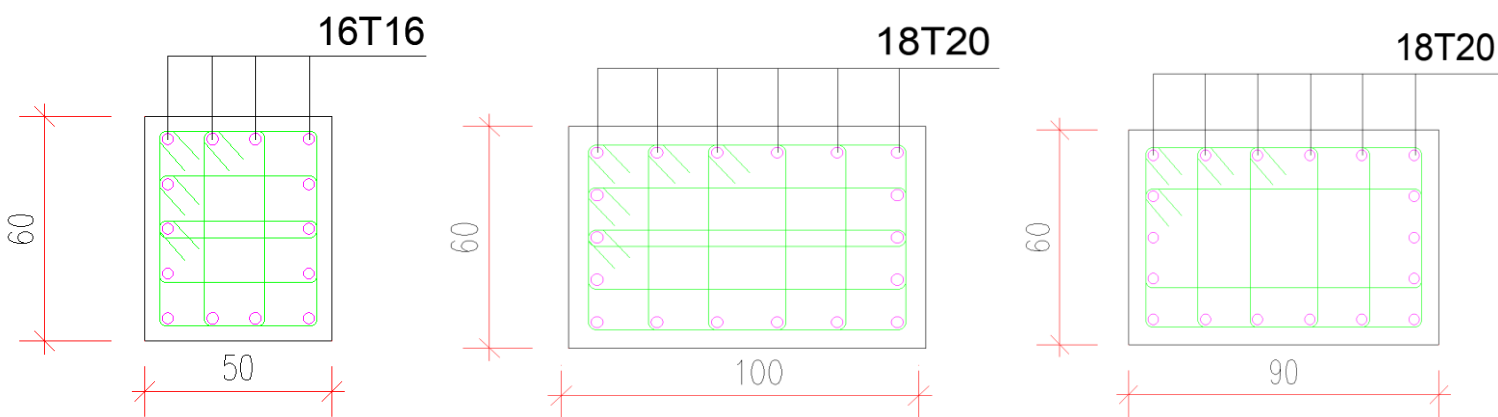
ferrailage des poteaux de bloc d'entrée.
